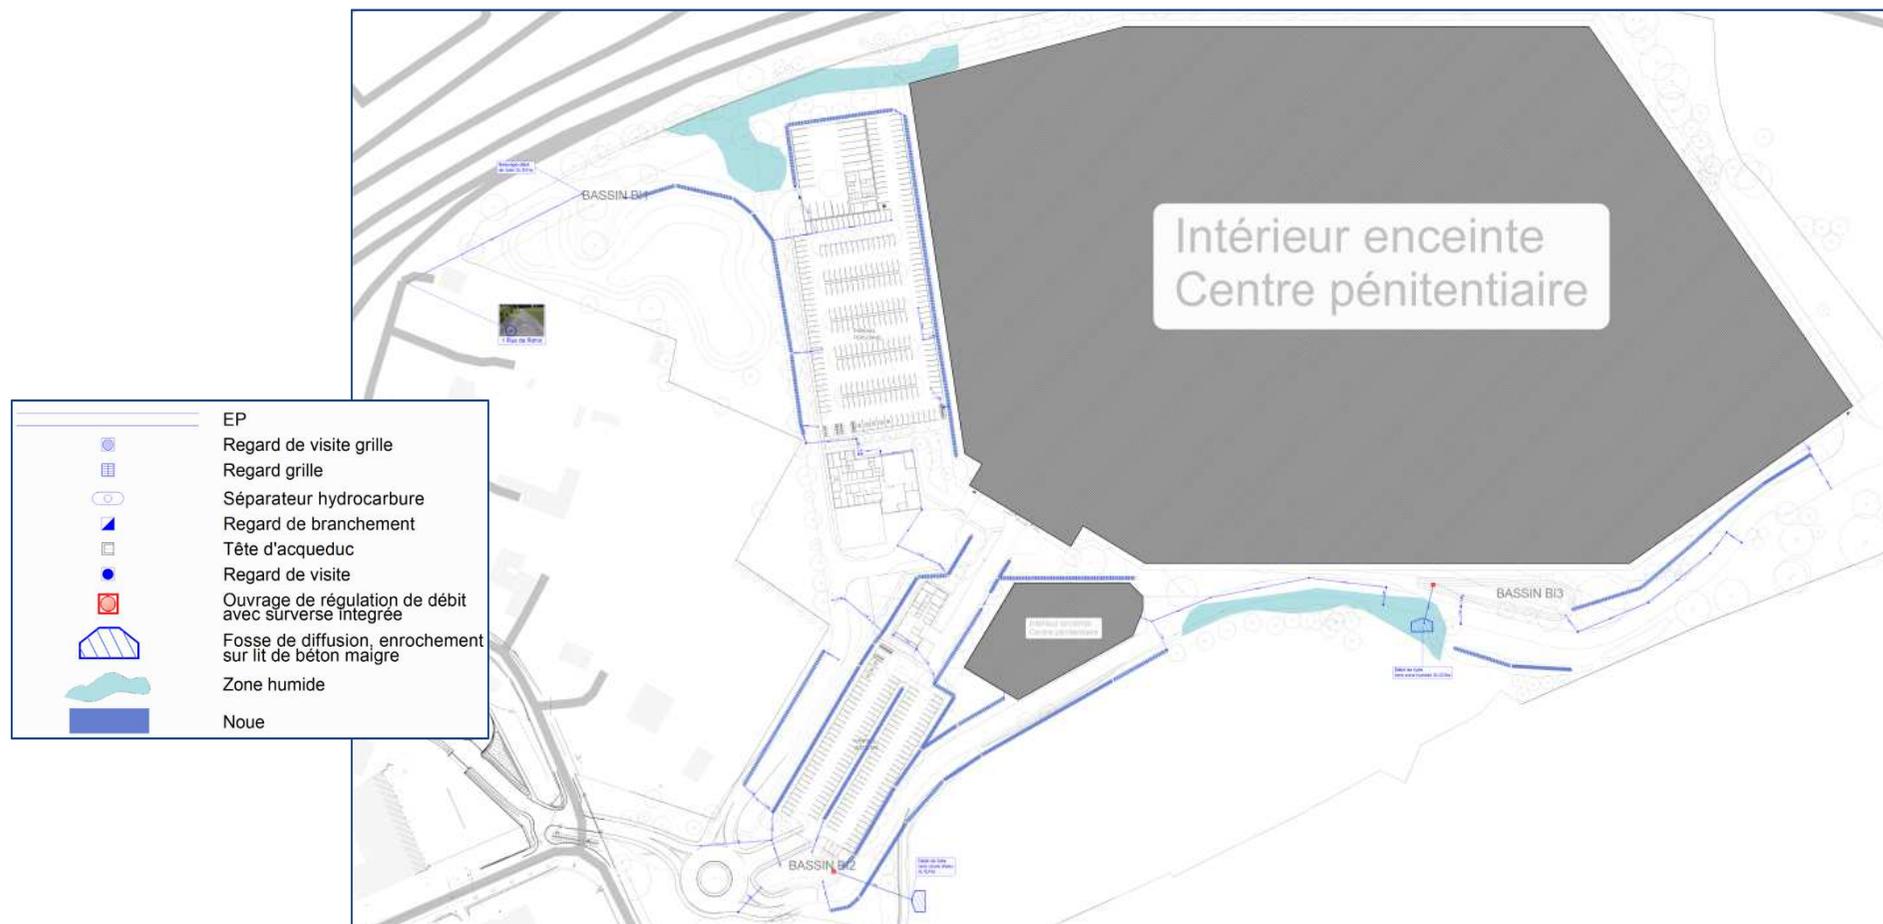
Plan de gestion des eaux pluviales (Source : B4 Design & Engineering, novembre 2024)
